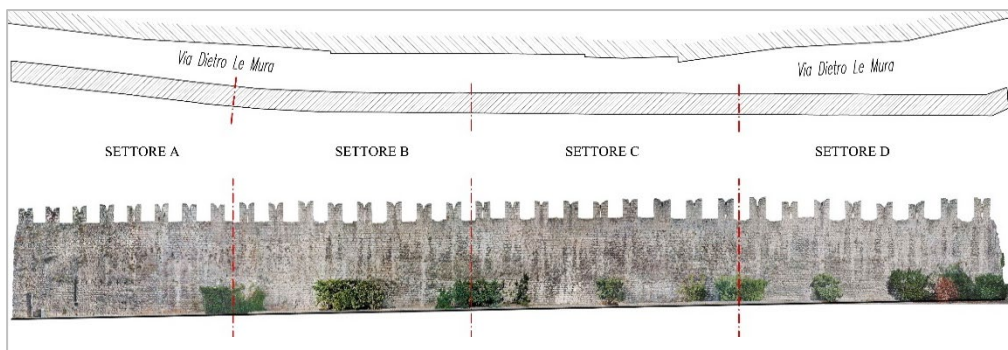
Planimetria con fotopiano del prospetto meridionale (rilievo di S. Franceschi, A. M. Lazzari, 2005).
